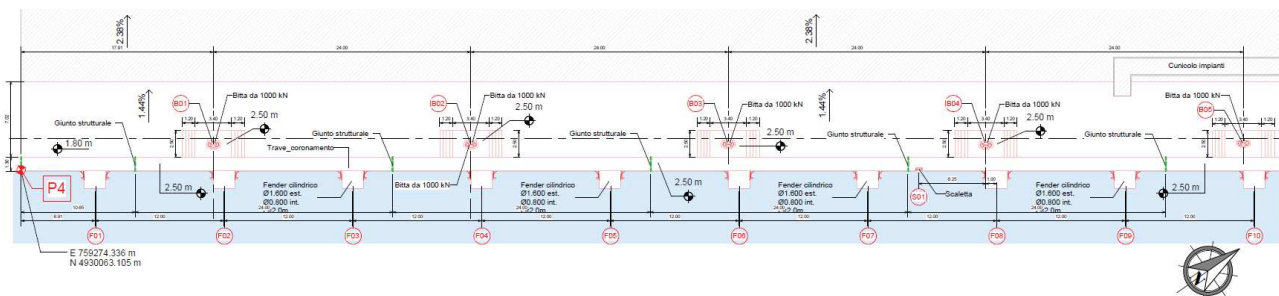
Alma – Planimetria di progetto / Quadranti 1-2.
